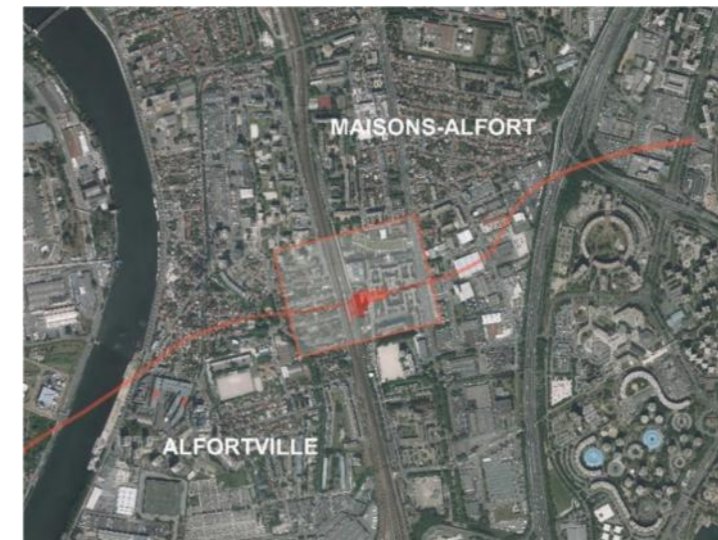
Plan de situation locale 1/5000ème - VPA. 23/12/2014
